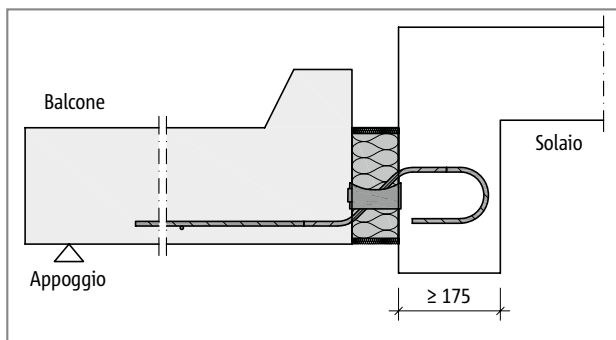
Schöck Isokorb® T tipo QL: situazione di montaggio "soletta del balcone prefabbricata"
